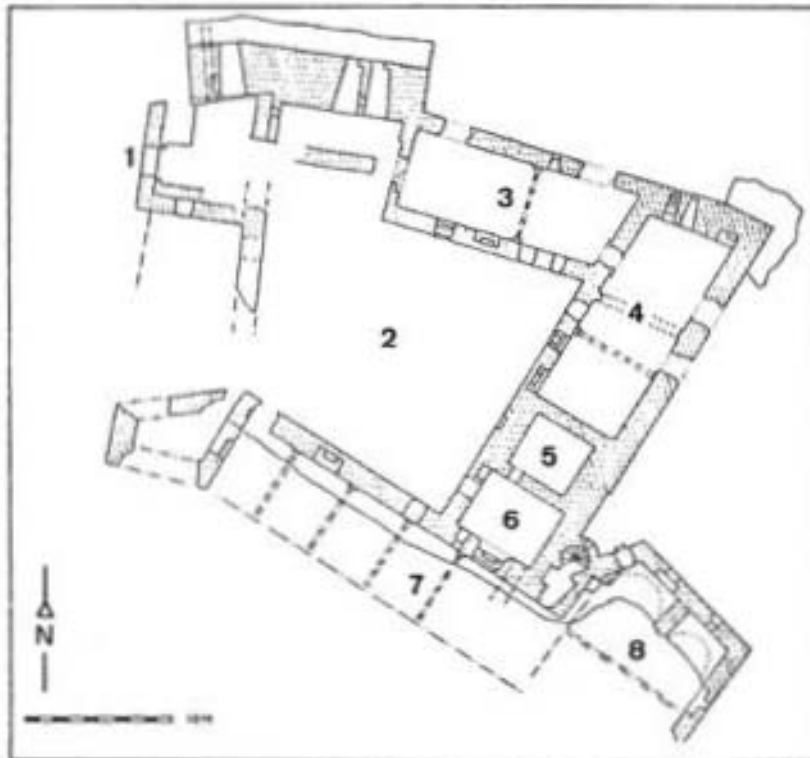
Plan de la partie castrale du site et localisation des salles évoquées dans le texte.
